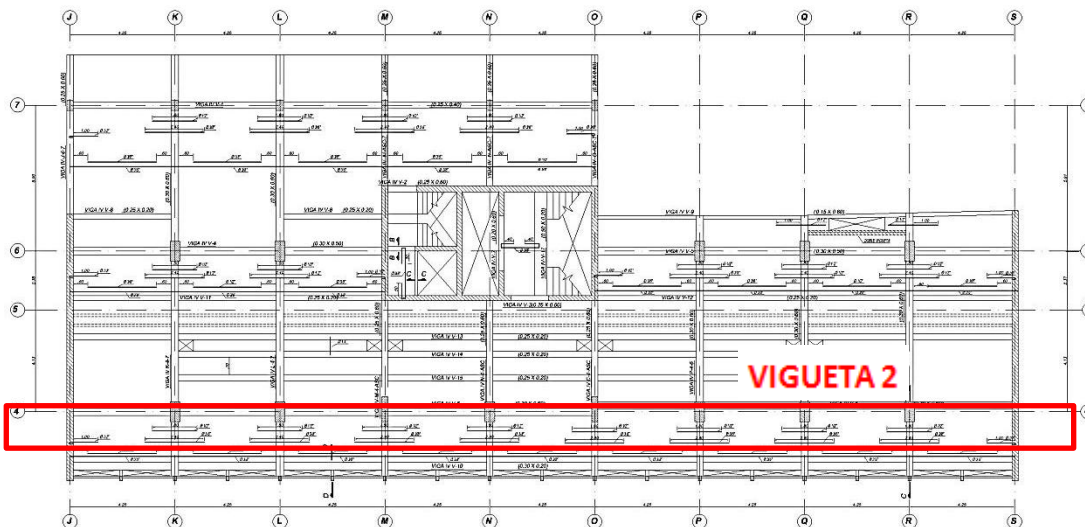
UBICACIÓN VIGUETA 2
